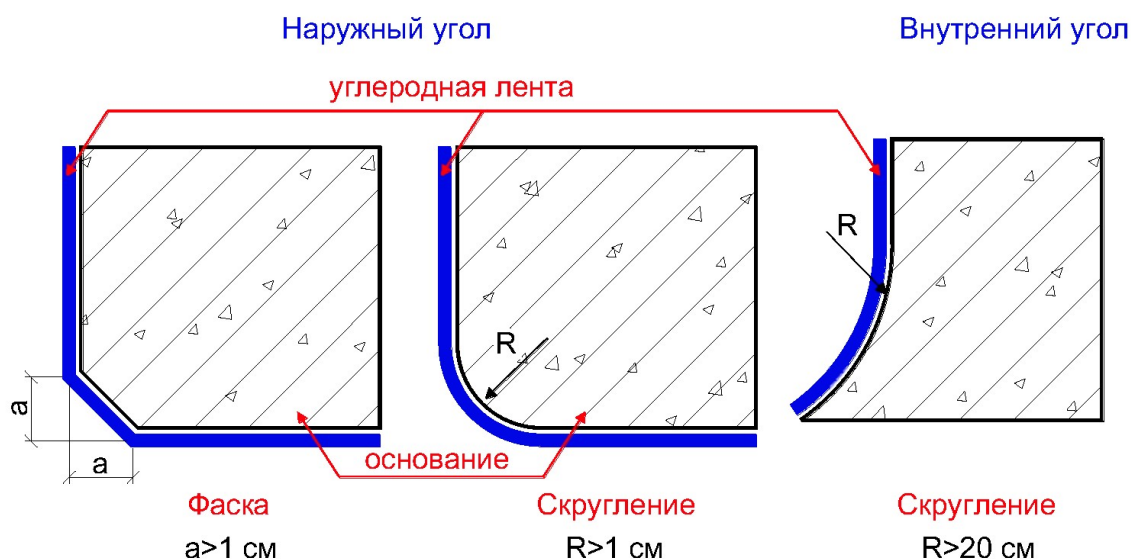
Подготовка углов конструкции перед наклейкой холстов
